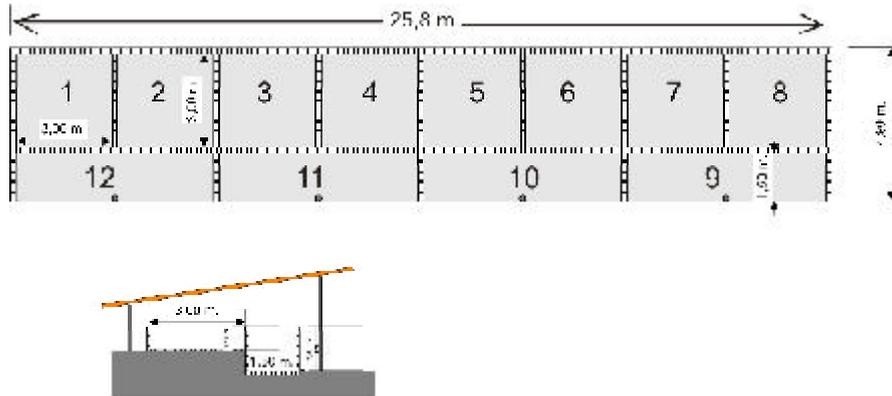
Planta baixa e corte das construções das câmaras de saturação e fermentação; sistema manual (DAI PRÁ, 2003)
